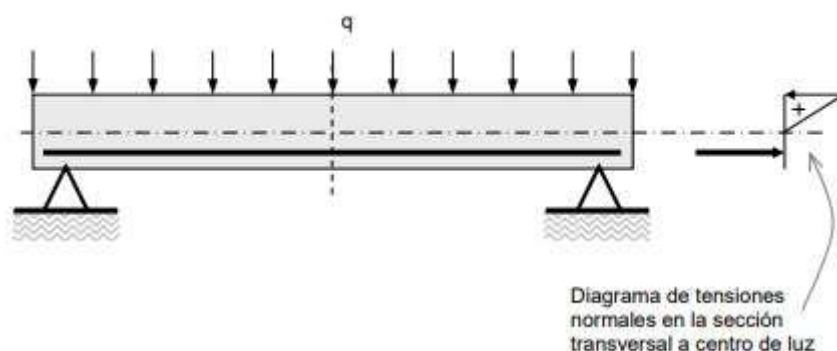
Viga de hormigón armado convencional sometida a cargas distribuidas.
